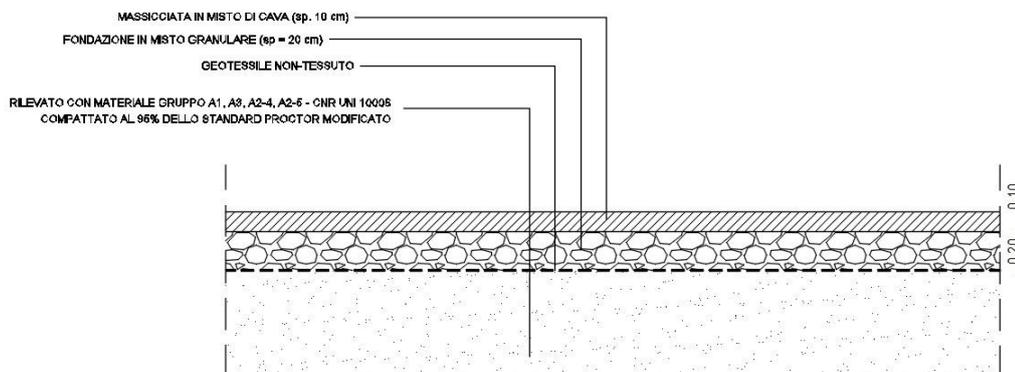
Pacchetto Pavimentazione Stradale "Tipo 2"
